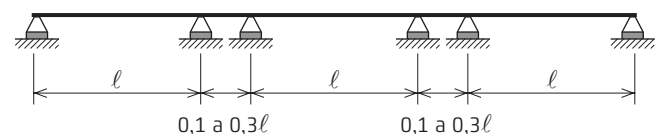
Exemplo de ponte em viga simplesmente apoiada com balanços (adaptado de Martinelli, 1978)
